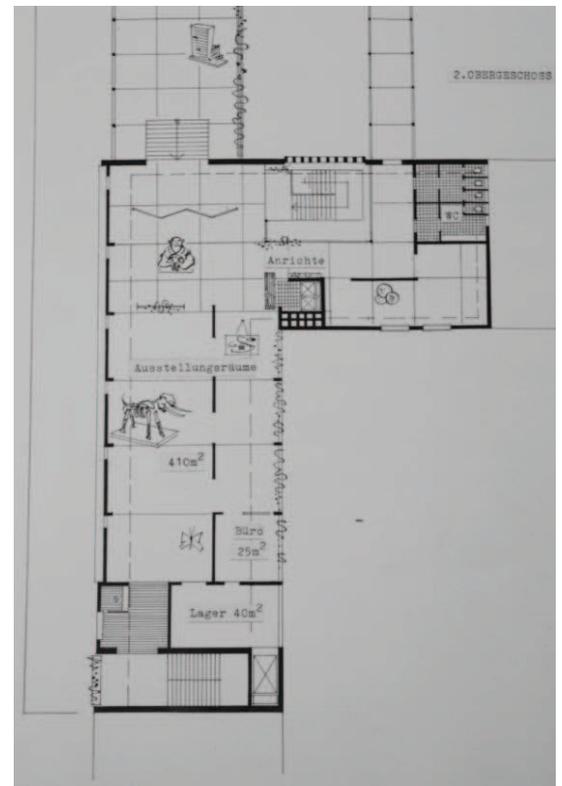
Kulturzentrum auf Tonhallengrundstück, Entwurf, Detail (StADu 72/ 306, Plan 3)
